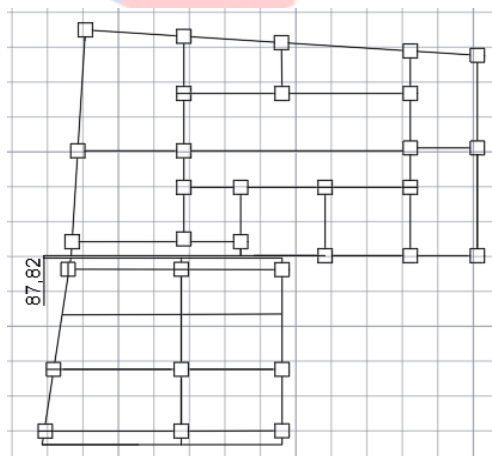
Jarak 250 mm Antara Bangunan B.2 dengan Bangunan C.1
